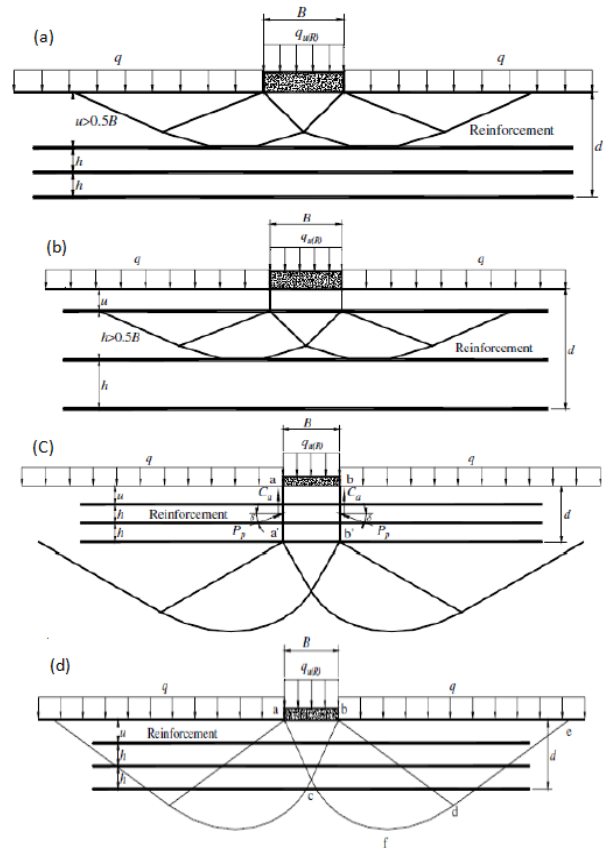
Mecanismos de falla de suelo reforzado ante cargas impuestas por cimentaciones superficiales, a-Falla por encima del refuerzo; b-Falla entre las capas de refuerzo; c-Falla debajo de las capas de refuerzo; d Falla en la zona de refuerzo (Sharma, et. Al. 2009).
